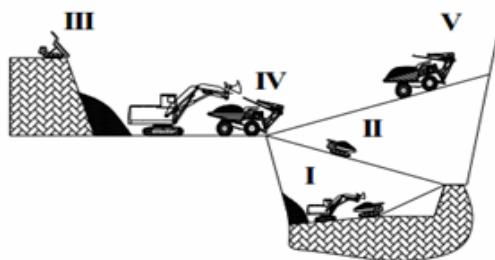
Устройство открытого перегрузочного склада на транспортной берме
